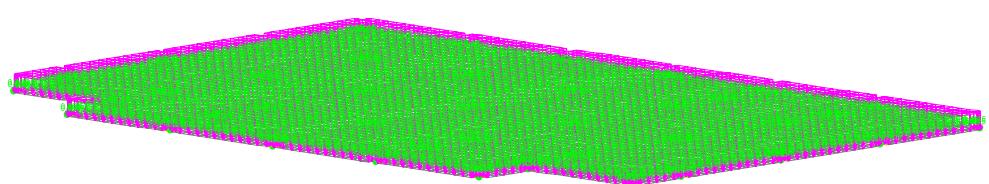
Нагрузка на монолитную плиту перекрытия подвала
